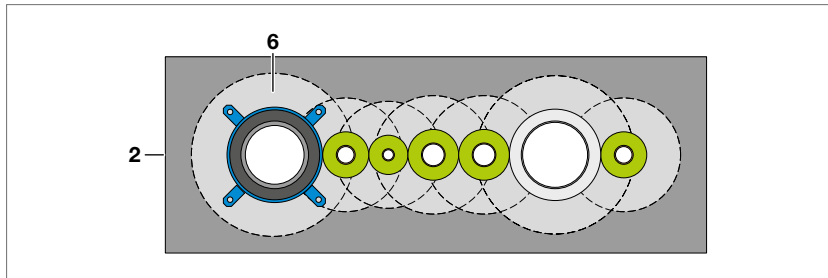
unzulässiger Deckenverschluss (fehlende Bewehrung im dunkelgrauen Bereich)
